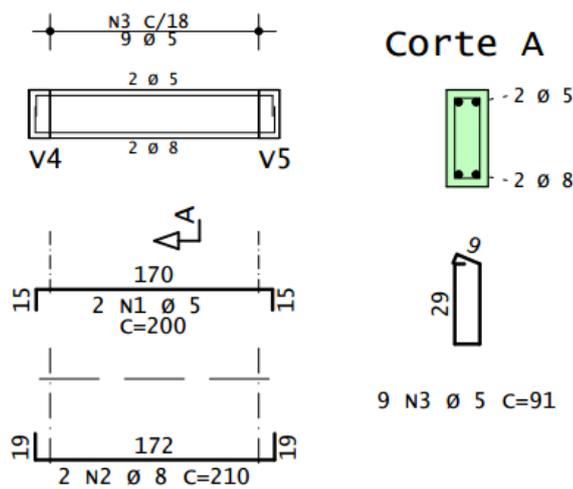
Armadura da viga baldrame V12 – pavimento térreo (nível 0,00)
